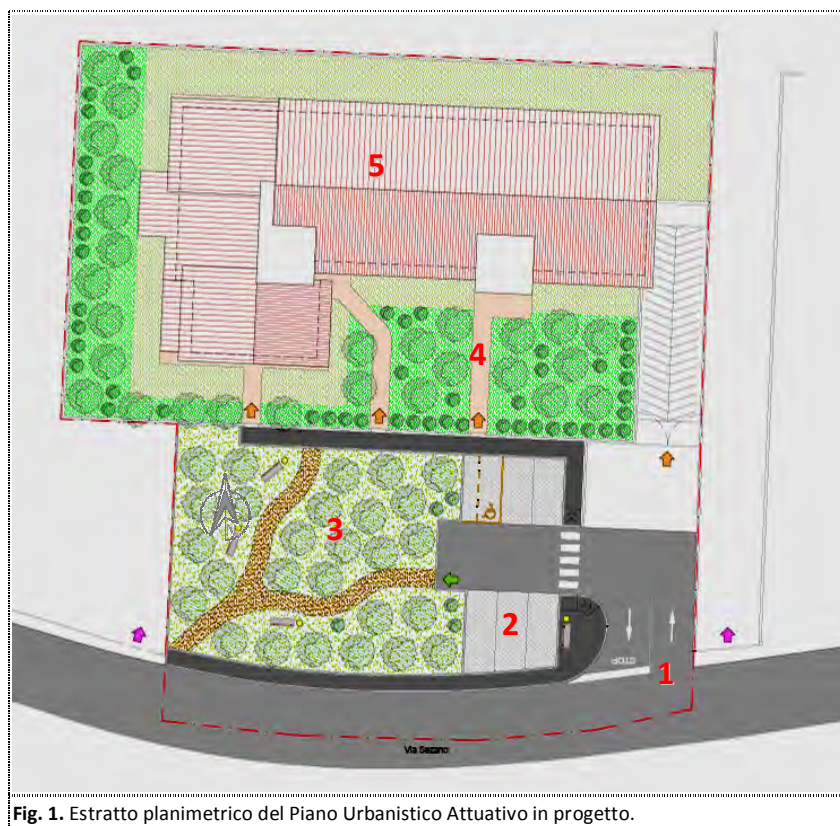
Estratto planimetrico del Piano Urbanistico Attuativo in progetto.
